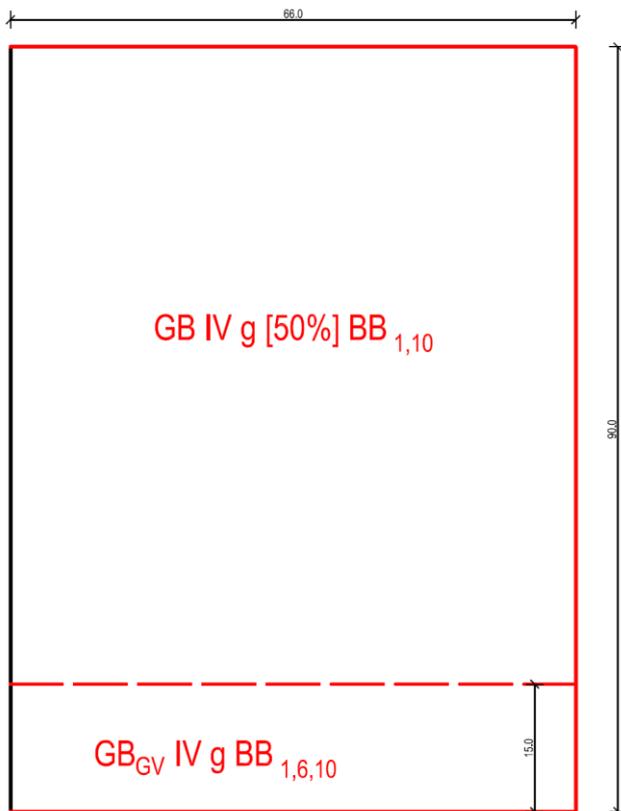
Skizze Grundstück 672/139: Babara-Prammer-Allee, 1220 Wien
